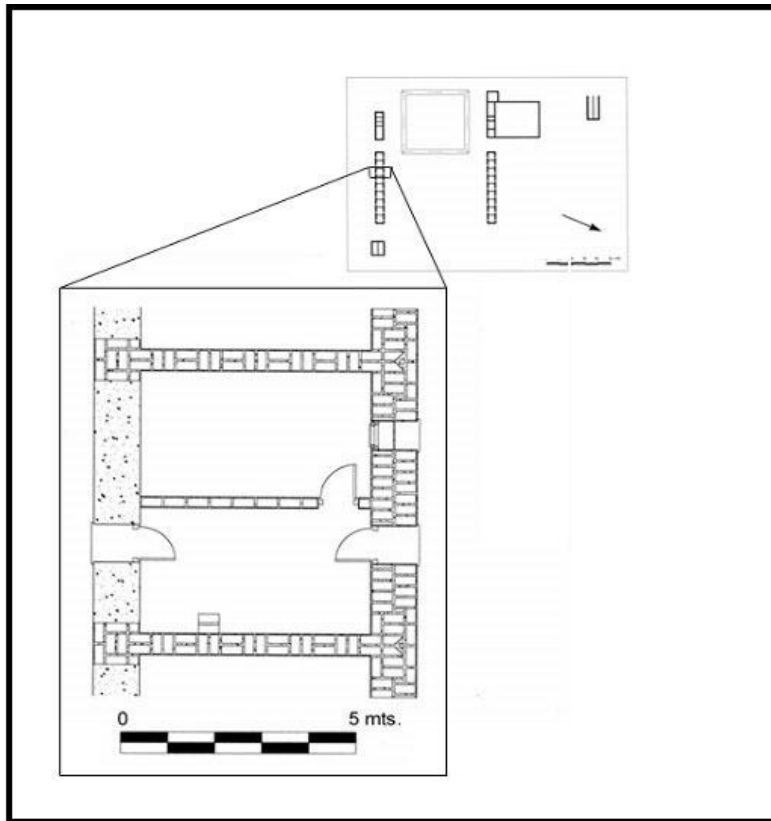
La vivienda tipo de la familia pobladora. Localización del plano arqueológico de Floridablanca (Ala Sur II, estructura 6). Se detallan con diferentes tramas los materiales y técnicas constructivas adobe y tapial.
